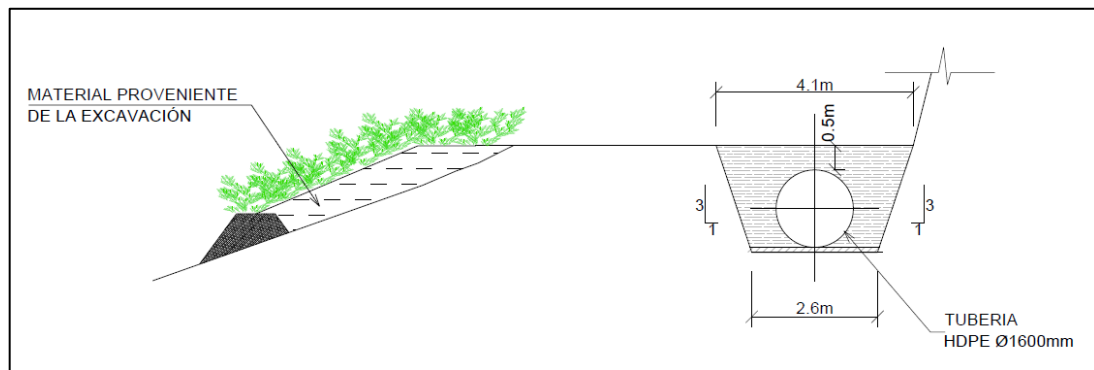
Esquema de revegetación de laderas con material de excavación.
